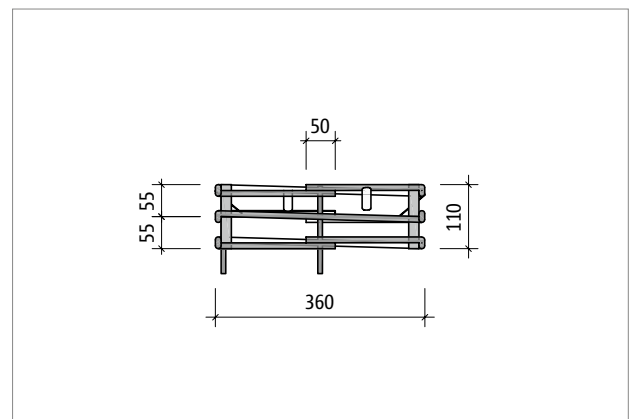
Schöck Scconnex® Typ P-B400: Seitenansicht Part T; geschweisste Bügel und Biegeformsegmente aus Edelstahl
